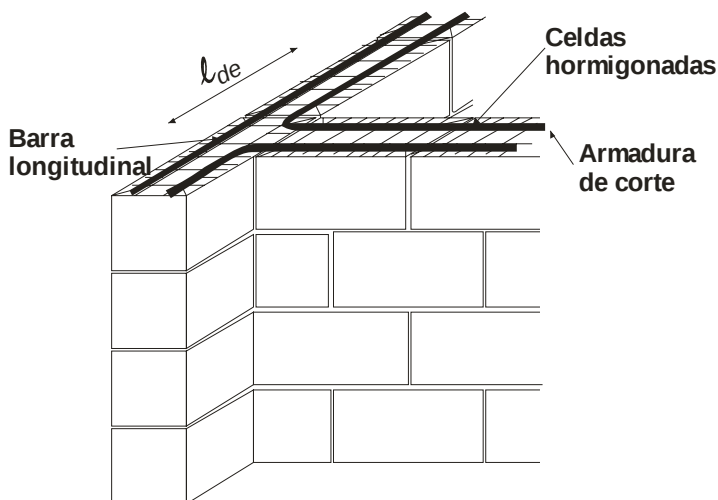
Anclaje de la armadura de corte en la intersección de muros
